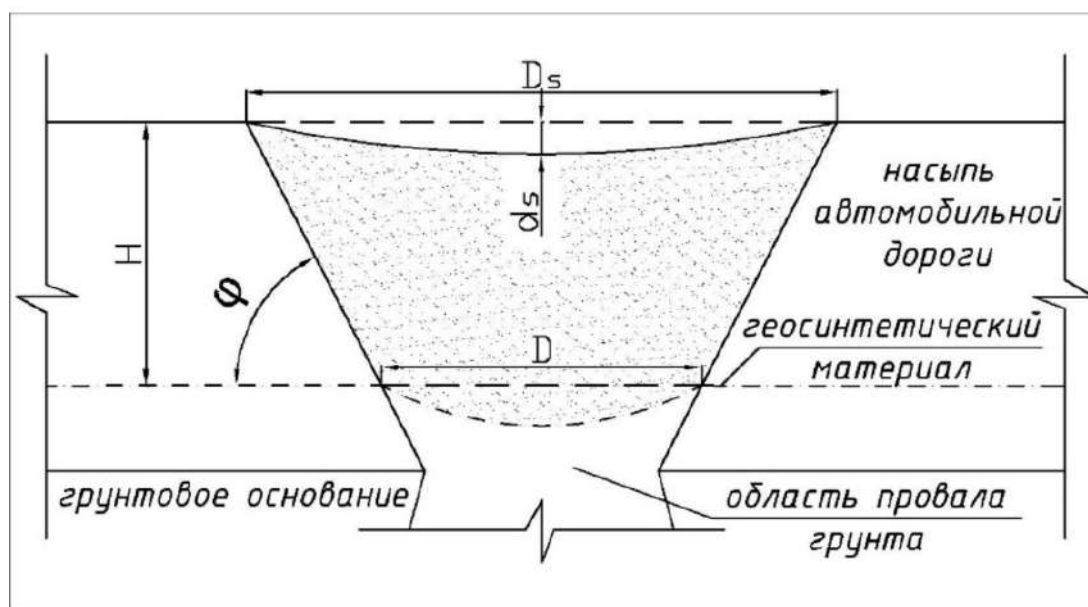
Расчетная схема осадок армированного грунта
